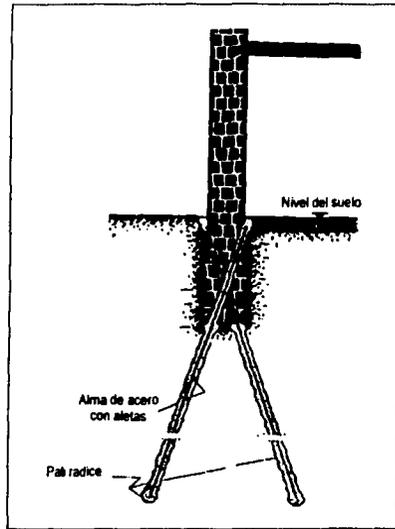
Recimentación de un muro con Pali Radice (corte)
